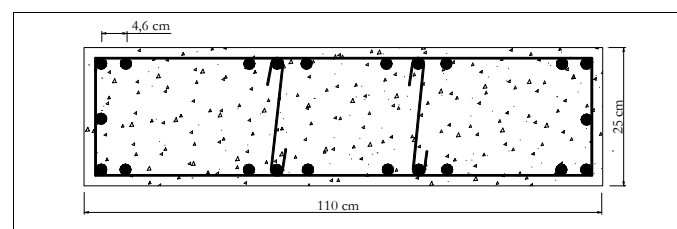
Caso 5: Arranjo das armaduras na seção transversal do pilar P1.
